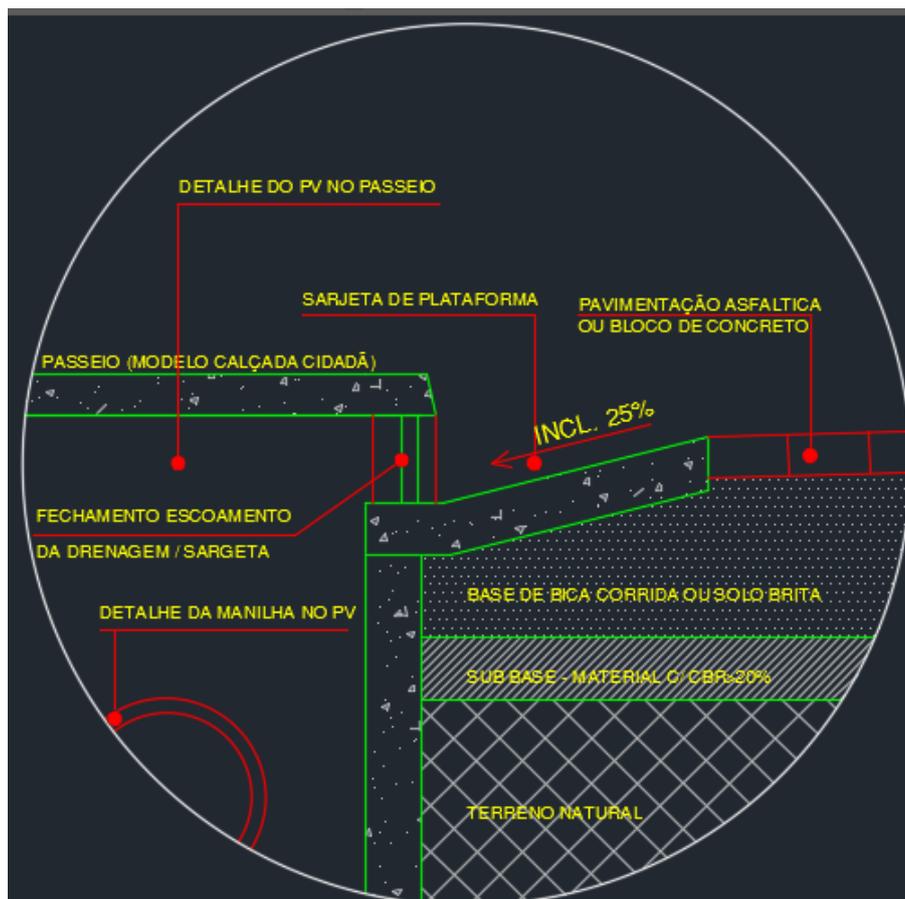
Seção tipo demonstrando as camadas do pavimento
